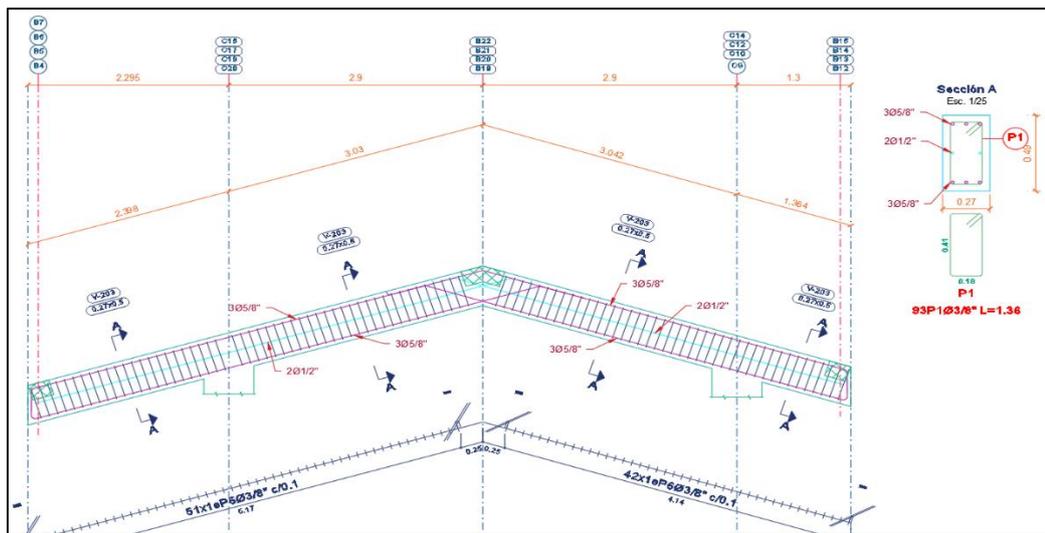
VIGA INCLINADA EN LA DIRECCION Y-Y EJES 2-2 AL EJE 7-7
